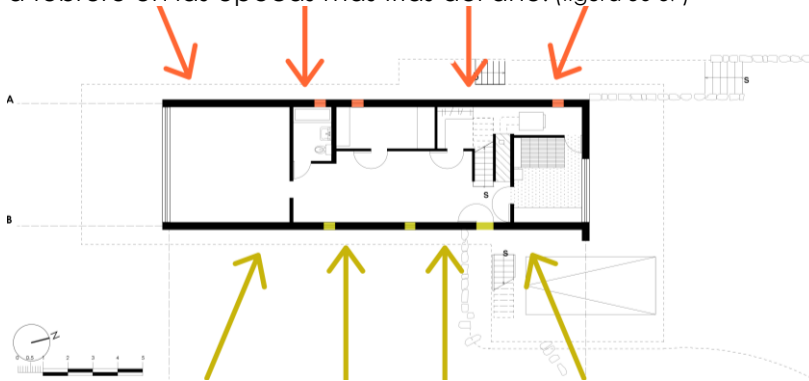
Ingreso de sol luz por las caras este y oeste del proyecto Planta baja.
